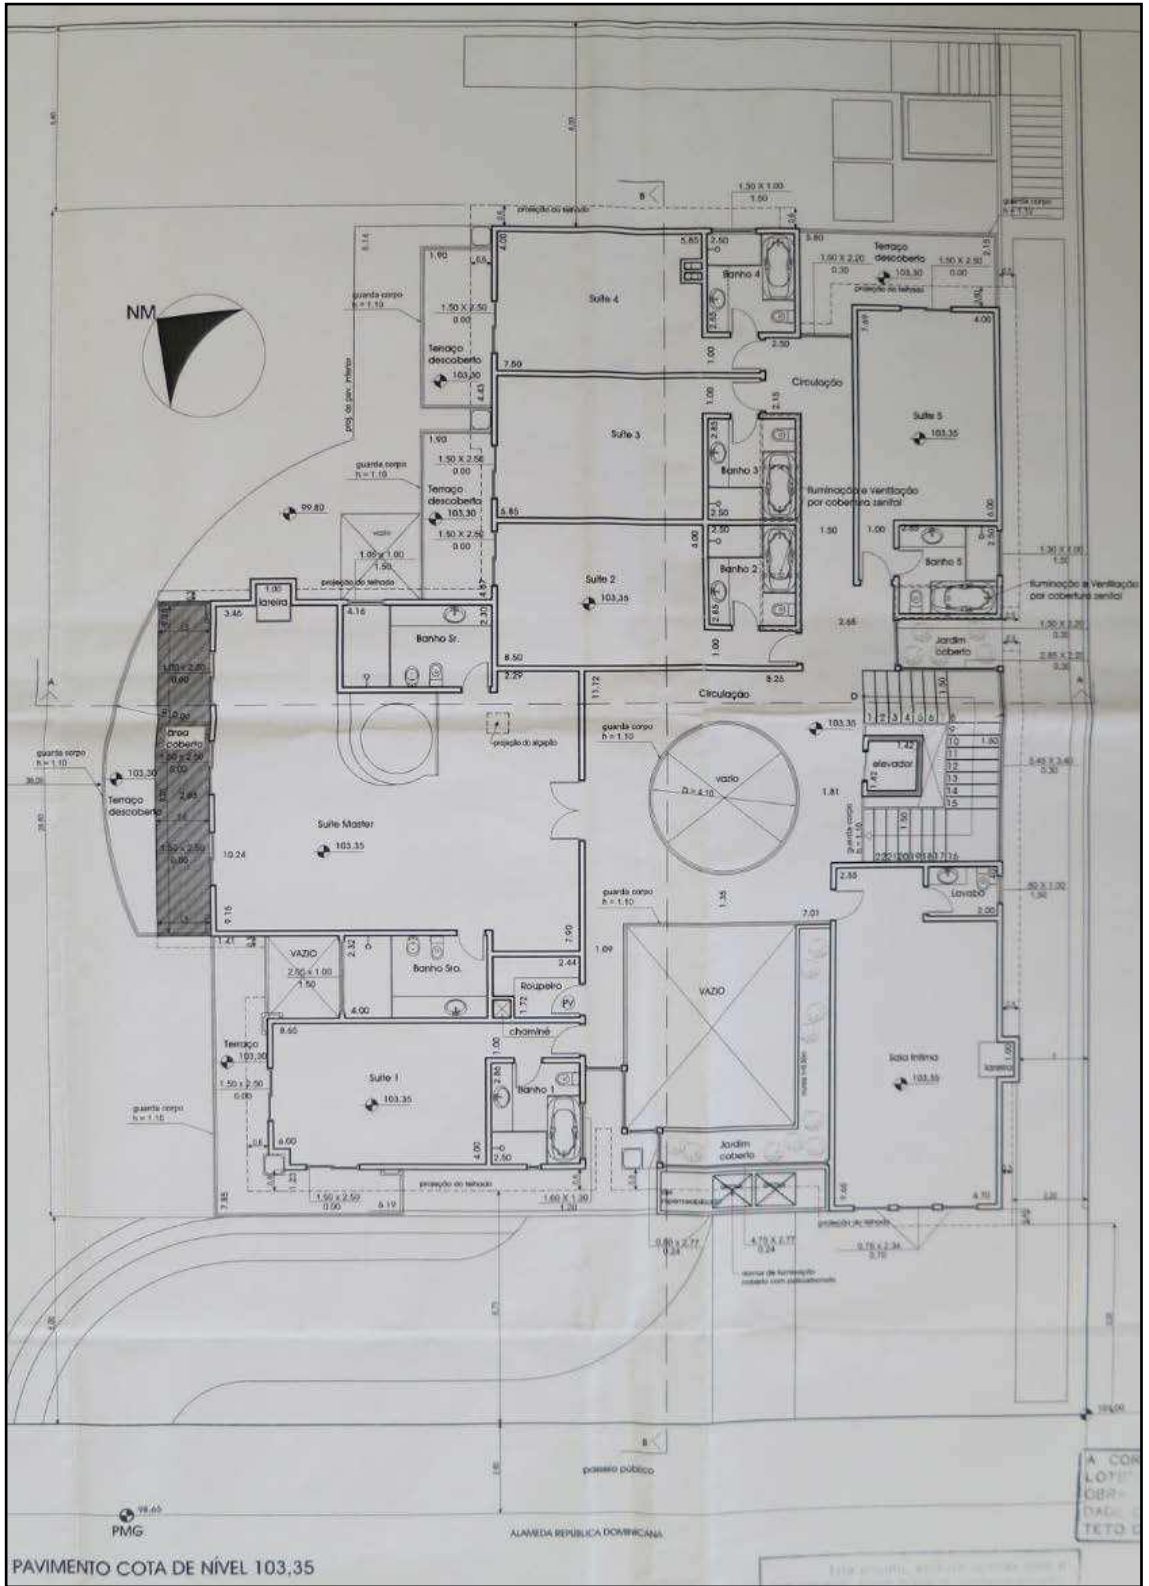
Cópia da planta do pavimento da cota 103,35 (área íntima).
